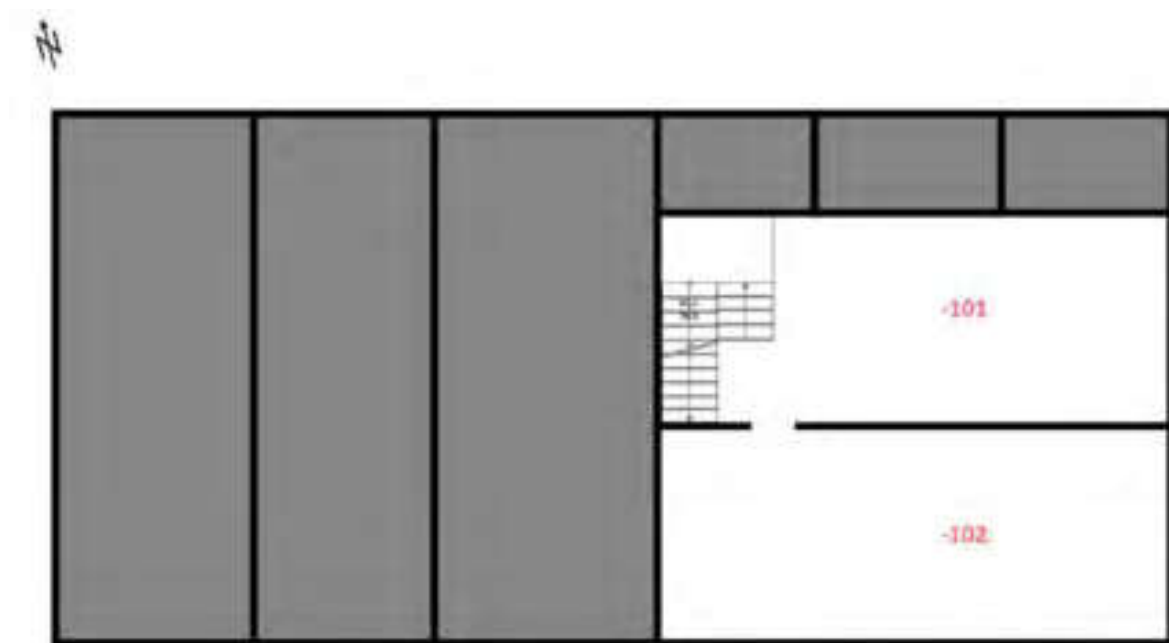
Schematischer Grundriss Keller, Bearbeitung IBID.
